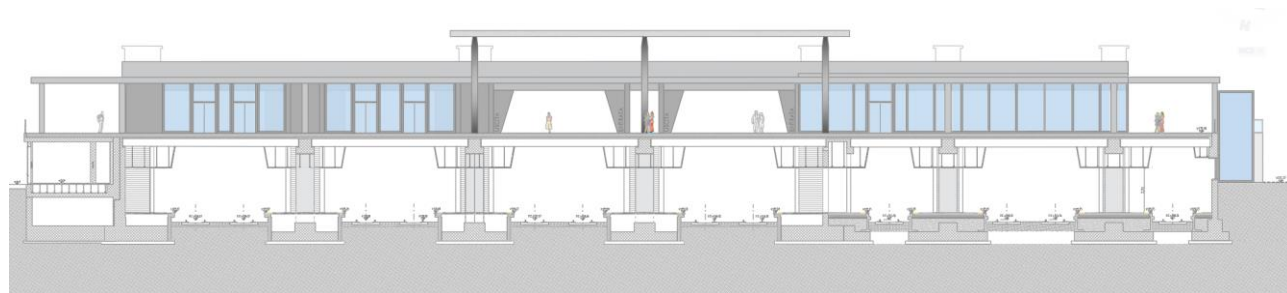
Sezione trasversale Piano Banchine nuovo (dx) ed esistente (Sx) in corrispondenza del piazzale.
